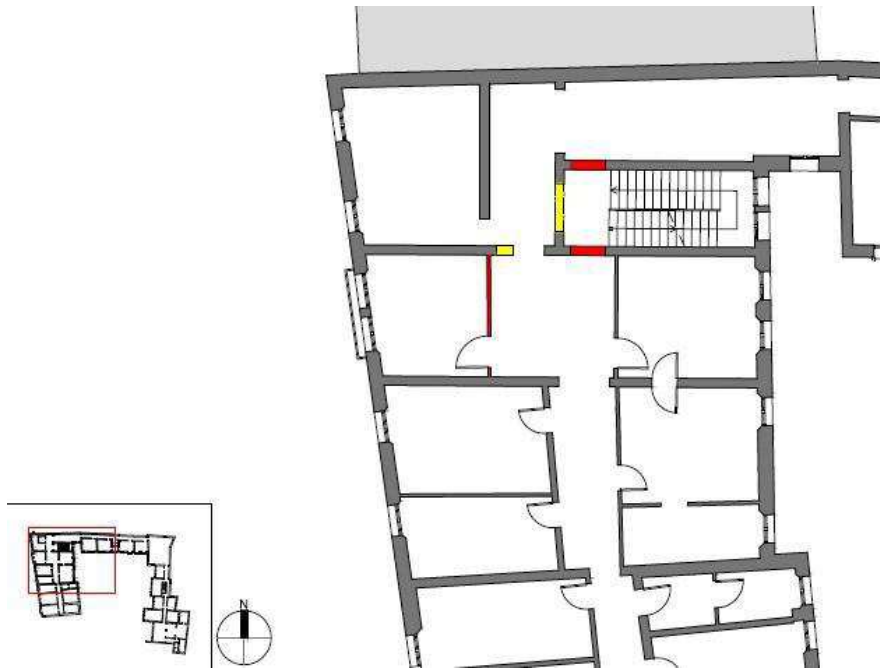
Tavola comparativa pianta piano primo – intervento del 1977
